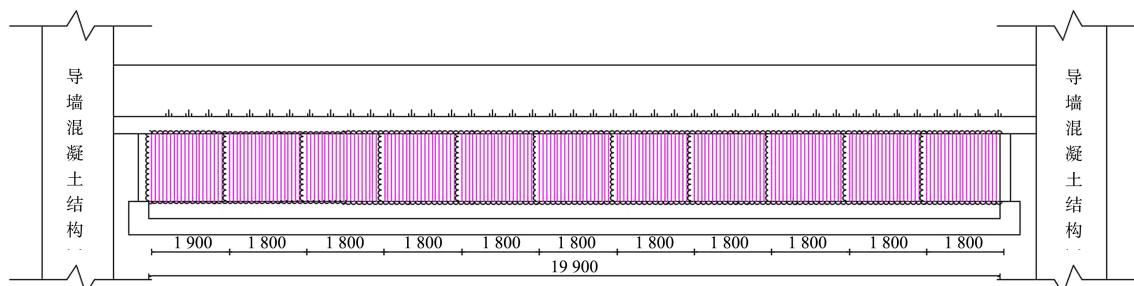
上游钢板桩围堰施工平面布置 (单位: mm)
